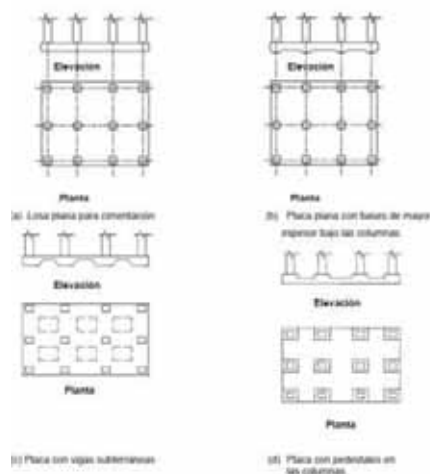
Losa de Cimentación. Fuente: UABC. 2010.
